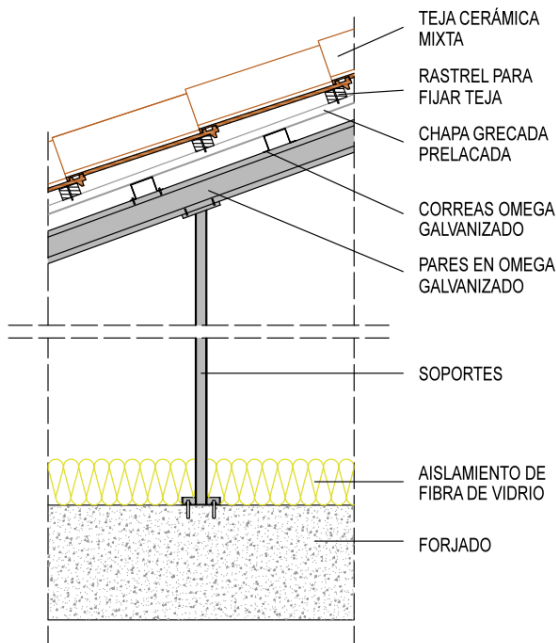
Sección de la propuesta elegida para la nueva cubierta. Fuente propia.
